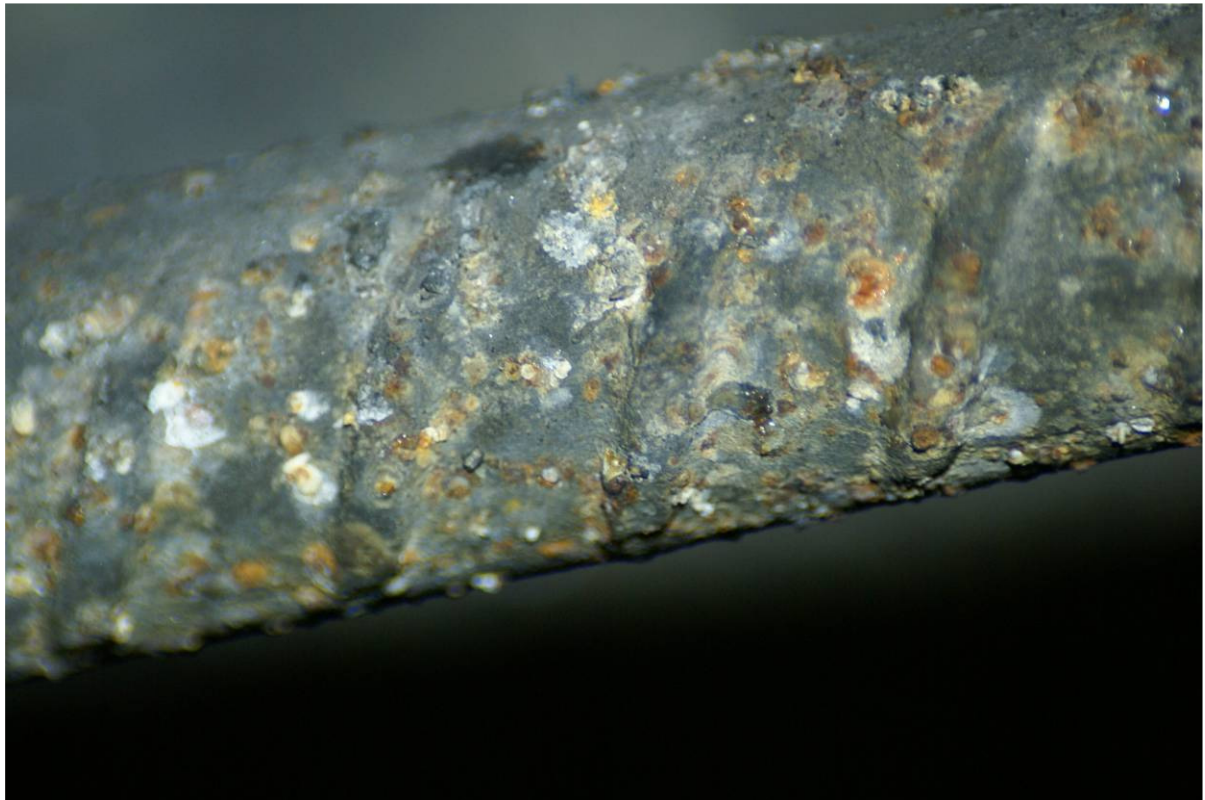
Bolt uten synlig korrosjon. Sprøytebetongfragmenter på utstikkende bolteende
